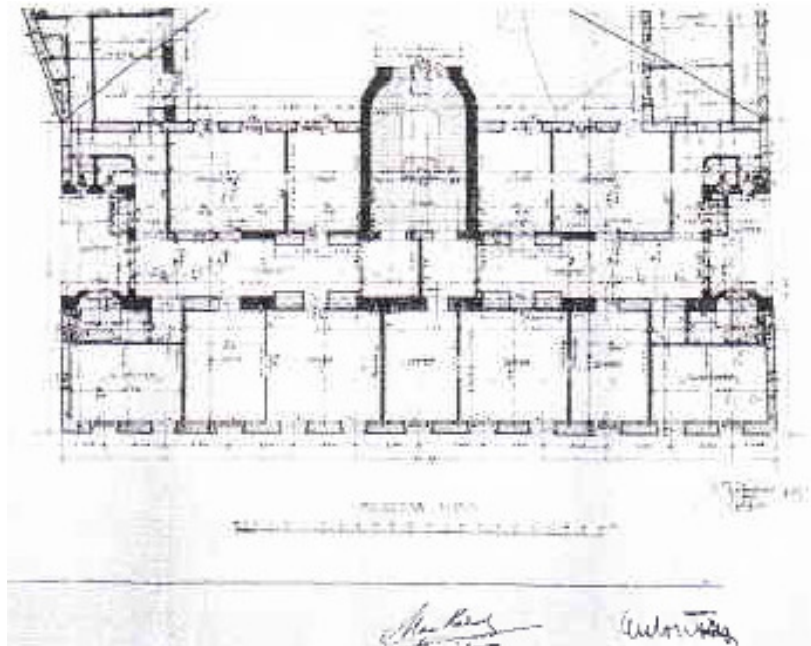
Portois & Fix, Grundriss der Wohnetagen.
